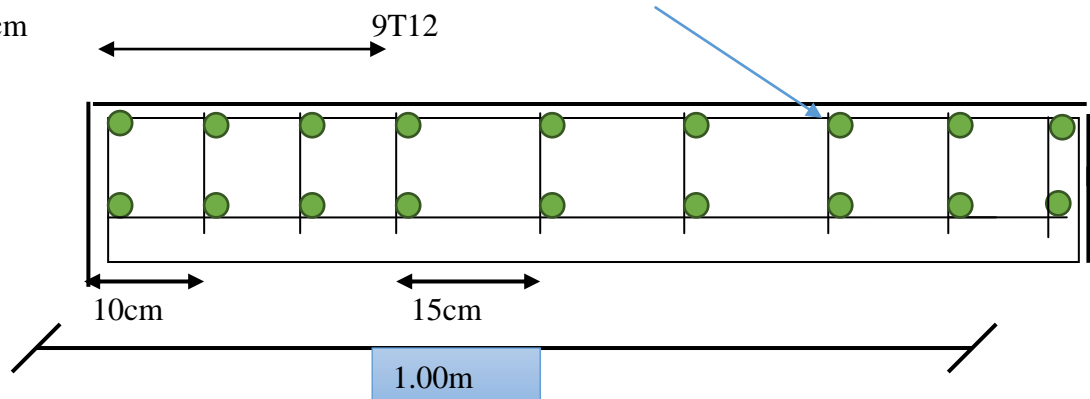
SCHEMA DE FERRAILLAGE (1/2 voile)
